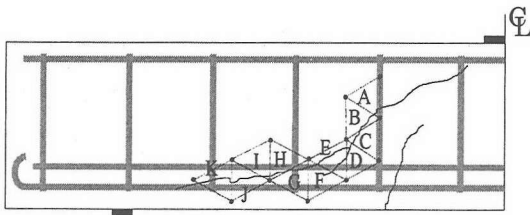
ひび割れ図および変位測定箇所 (S1)
